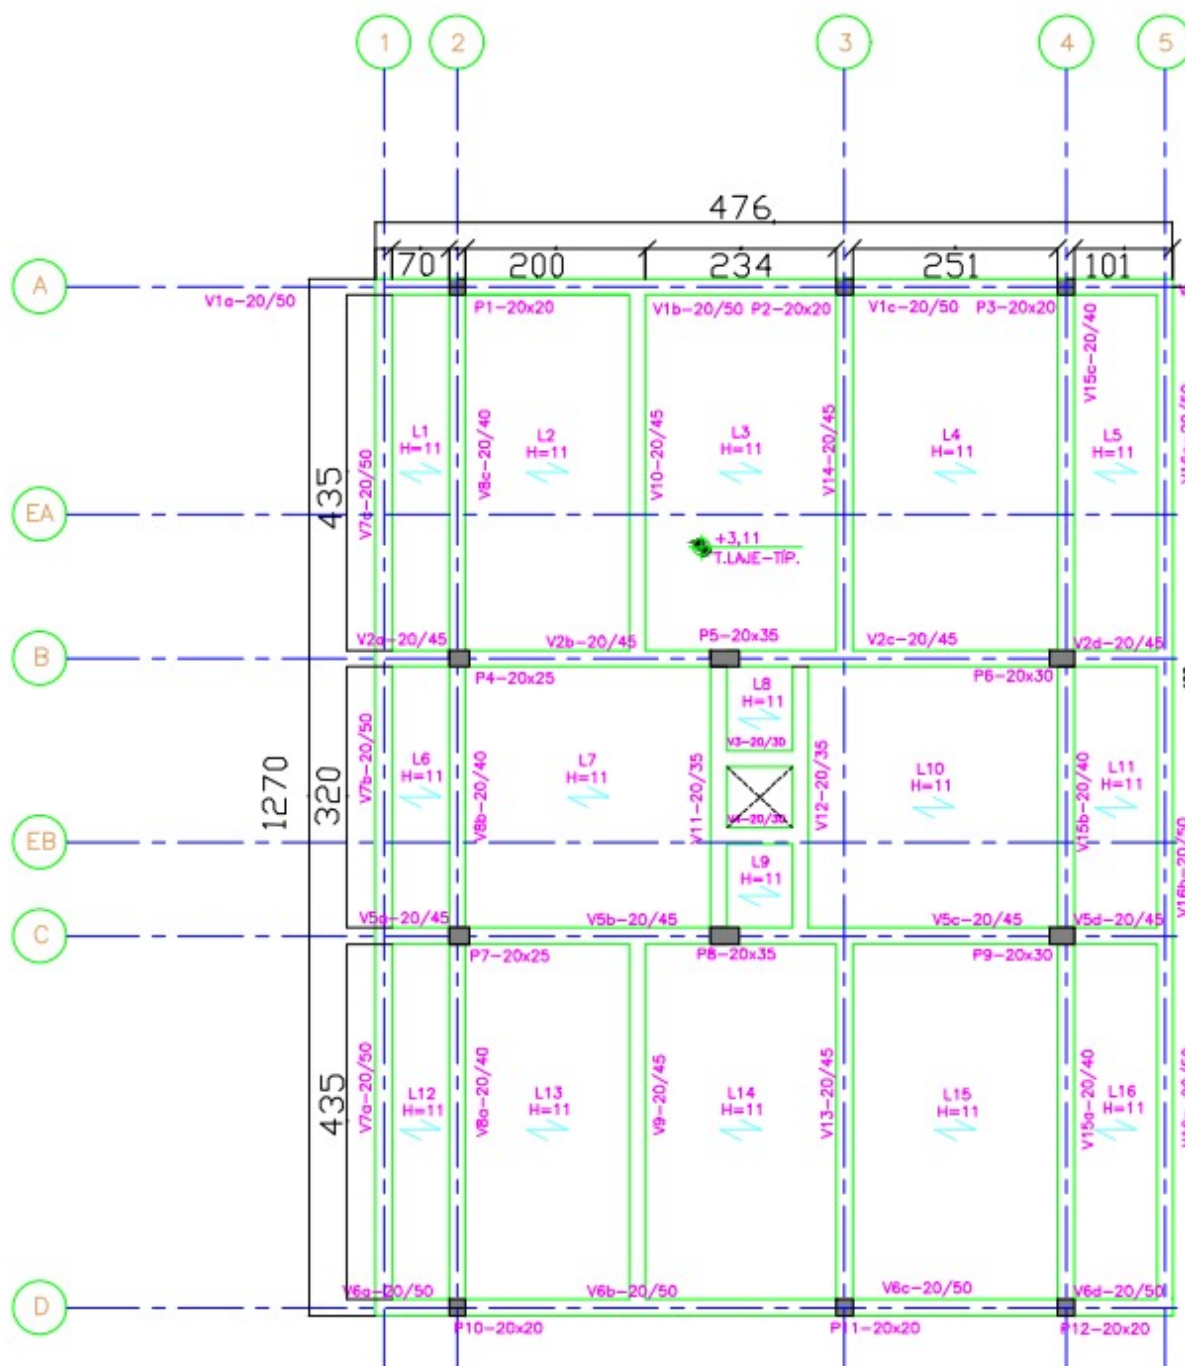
Planta de Forma do Piso do Pavimento Tipo
